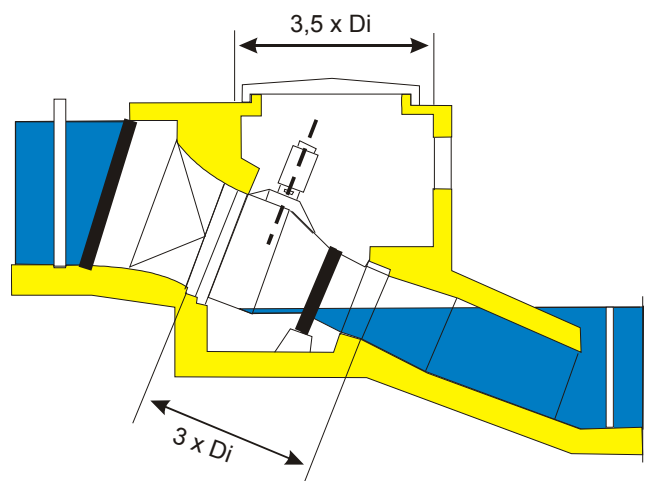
Coupe d'une installation de turbine Kaplan en S
